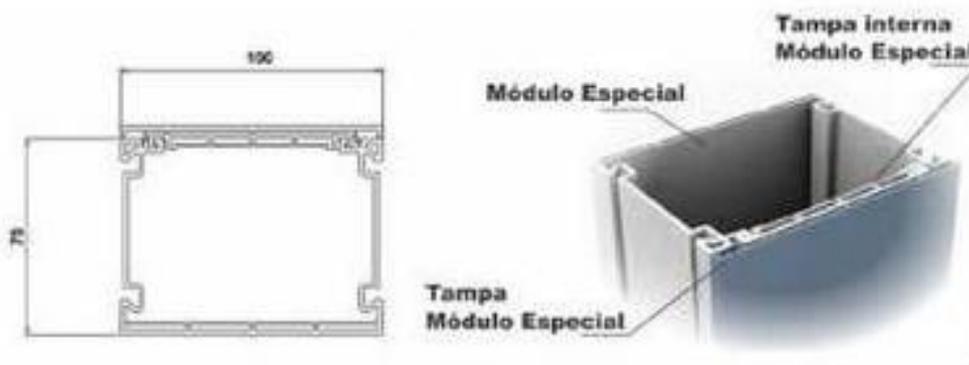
Módulo especial usado para passagem de tubulações hidráulicas
